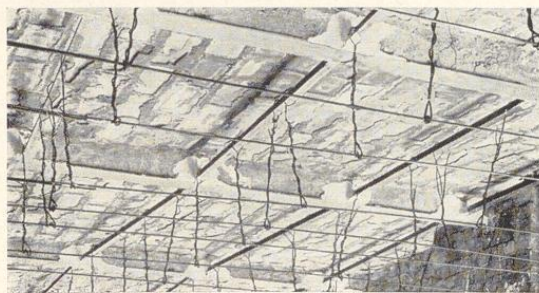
Gute Abhängung an einer eisernen Trägerdecke
